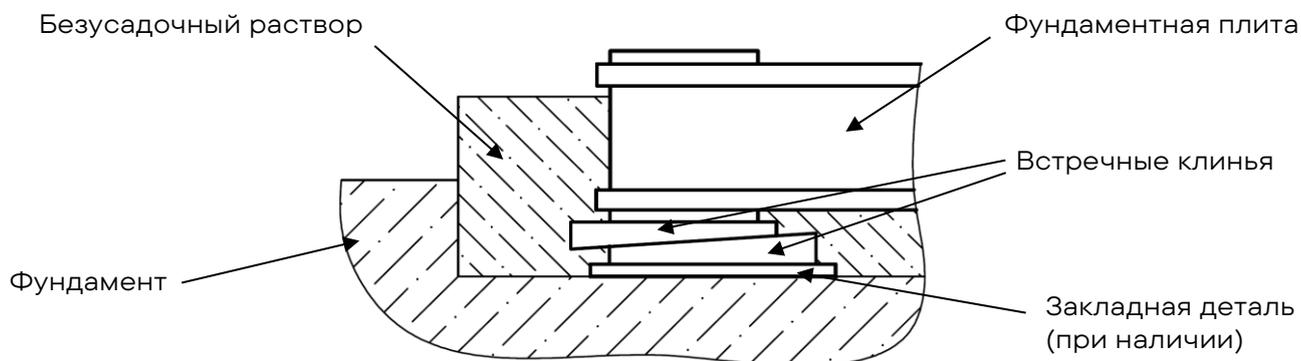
Установка фундаментной плиты на бетонном основании
